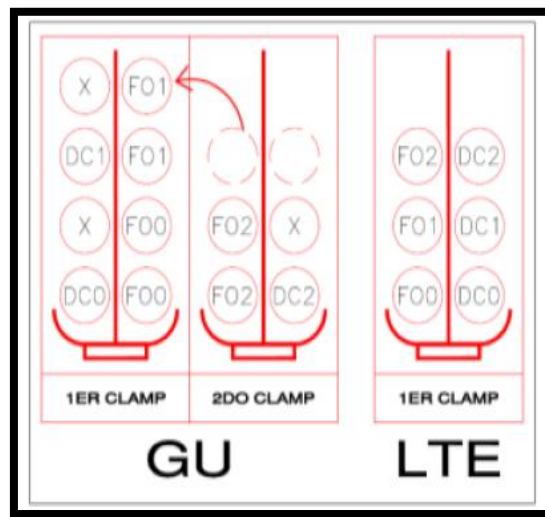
Clamp para cableado de F.O. y energía, Site Santa Teresa
